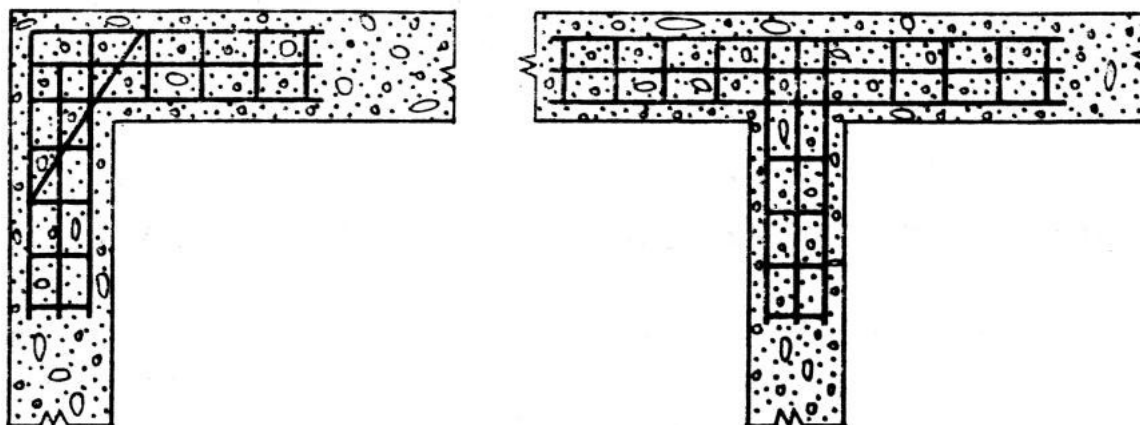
Схемы усиления углов и мест примыкания стен арматурными сетками
